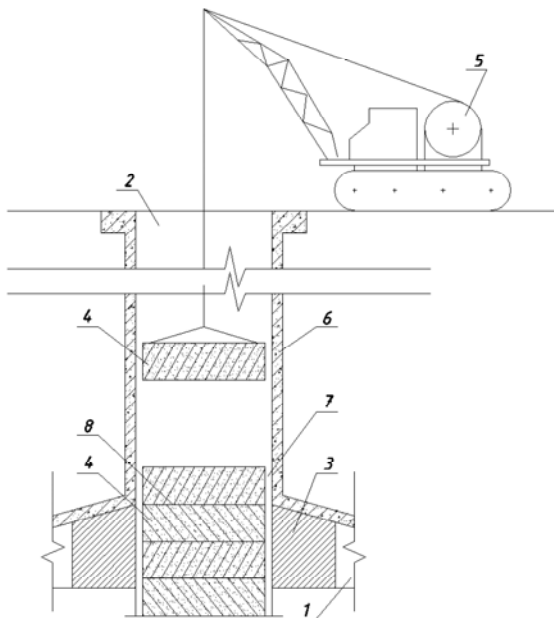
Схема закладки вертикального ствола крупногабаритными цилиндрическими автоклавными шлакобетонными блоками
